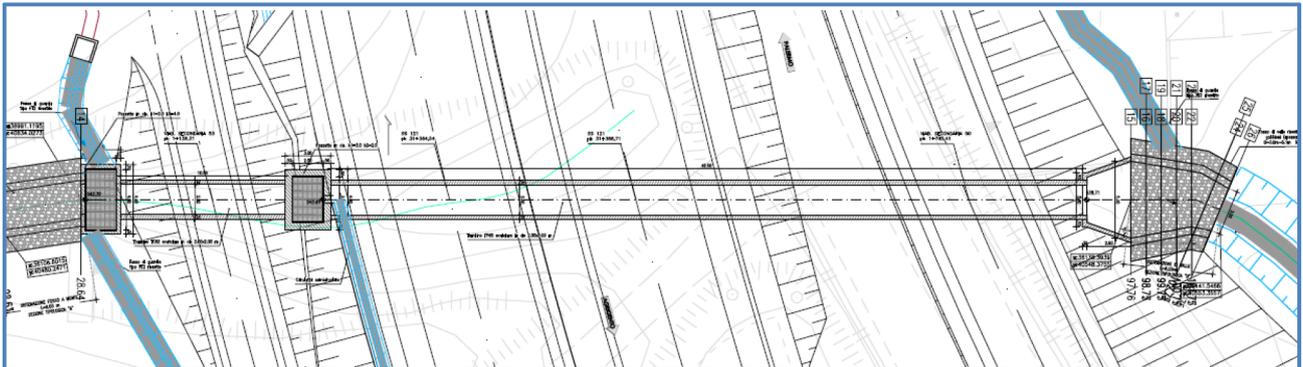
Stralcio planimetrico Tombino idraulico TP68.
